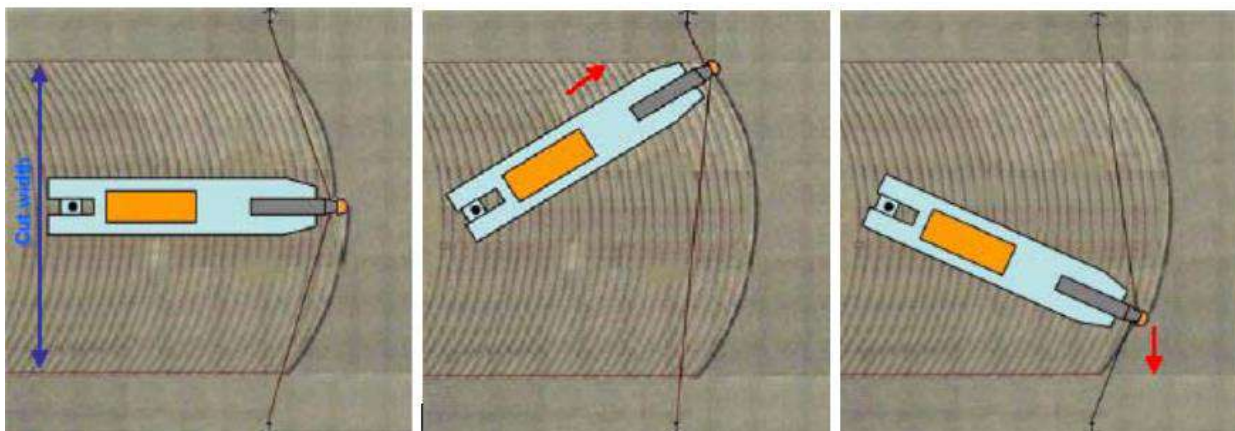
Землесосный снаряд с фрезерным рыхлителем: дноуглубление, вращение вокруг сваи
